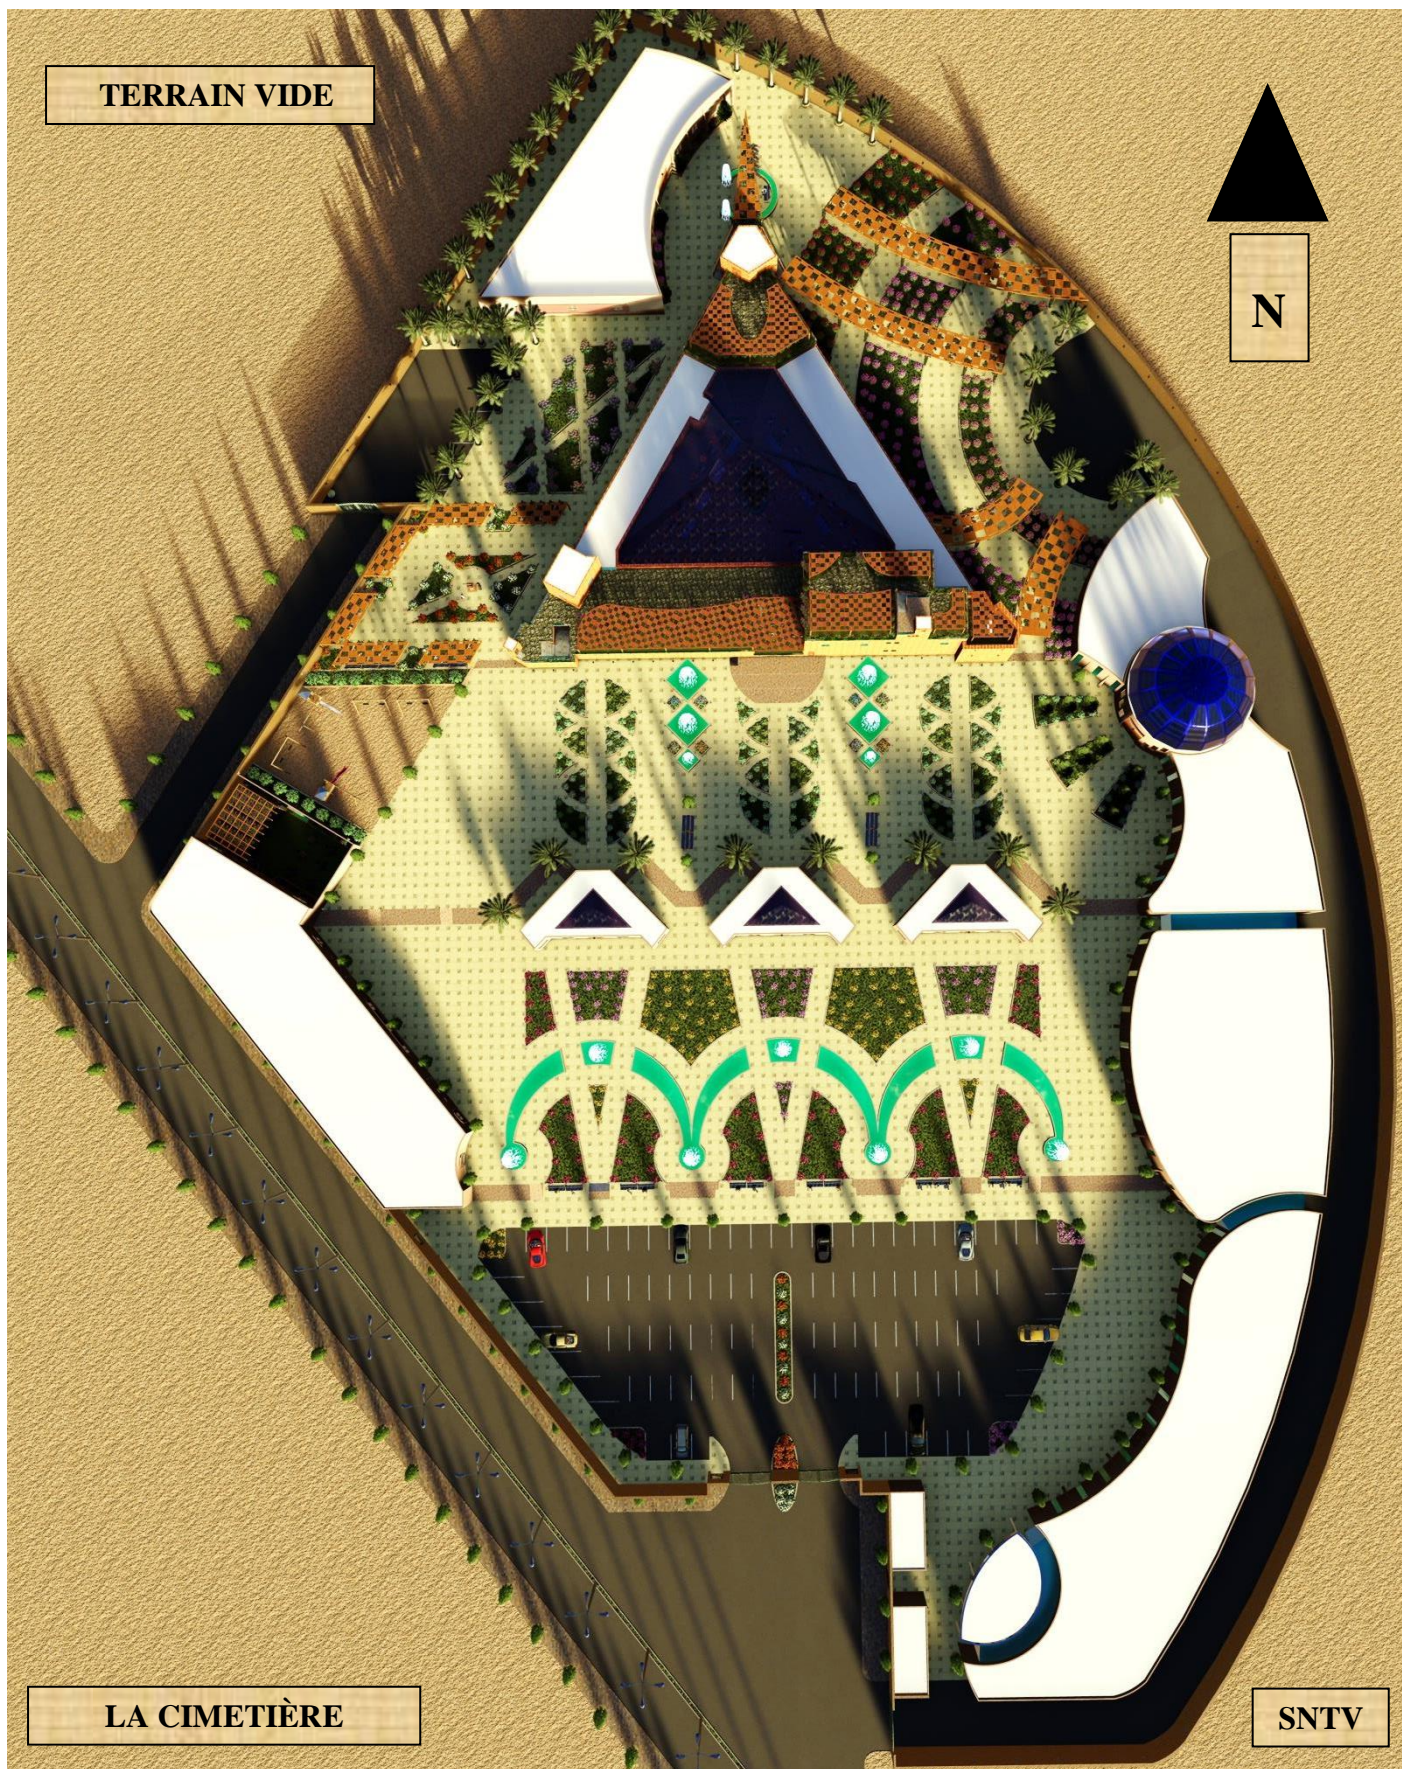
Plan de masse de projet 3D -Source : L'auteur
